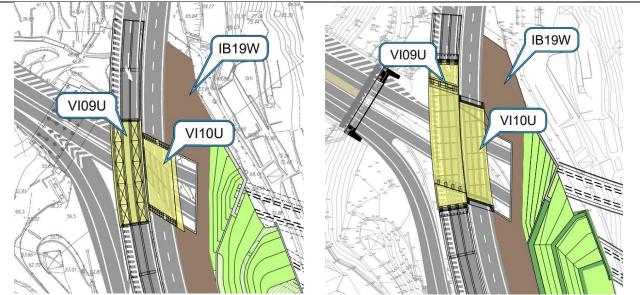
sistemazione finale nella versione di progetto approvato (a sx) e nella soluzione di variante (a dx)
